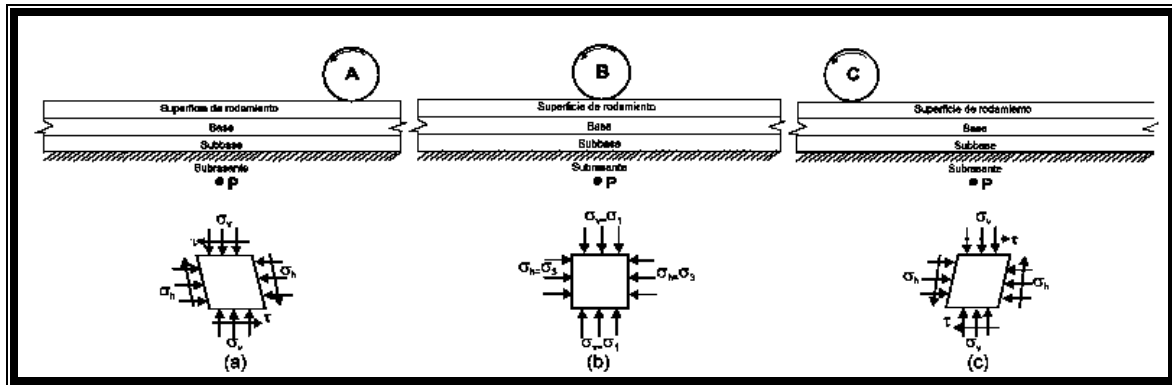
Estado de esfuerzos en una sección longitudinal de un pavimento.
